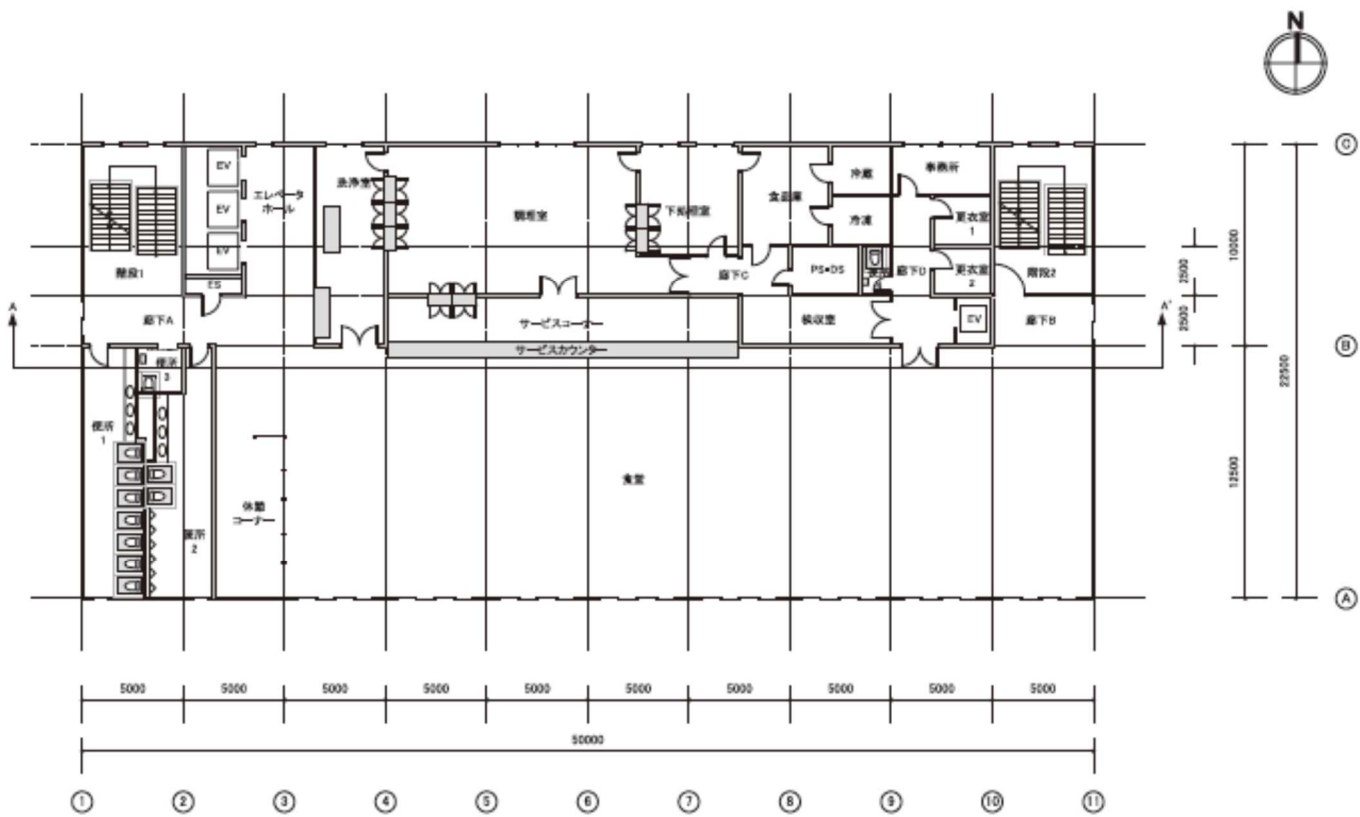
モデル建物（大学等、高層棟） 2階平面図
